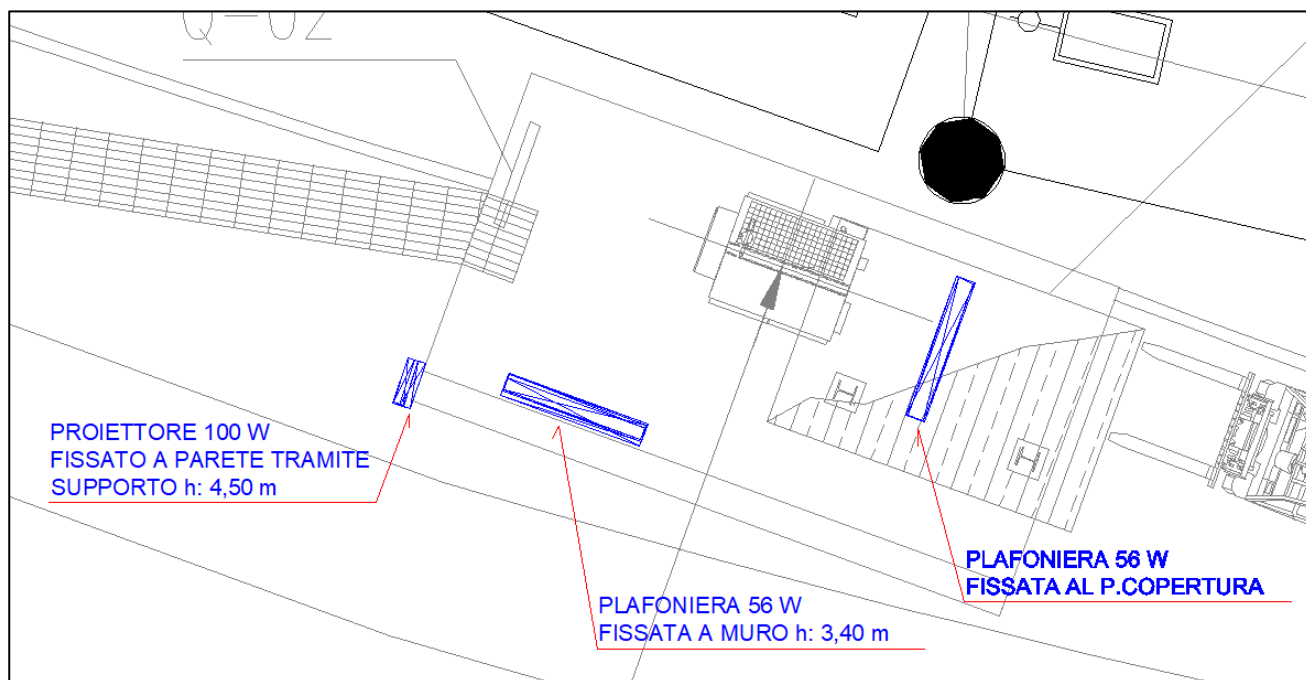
Dettaglio disposizione apparecchi Zona Dispenser
